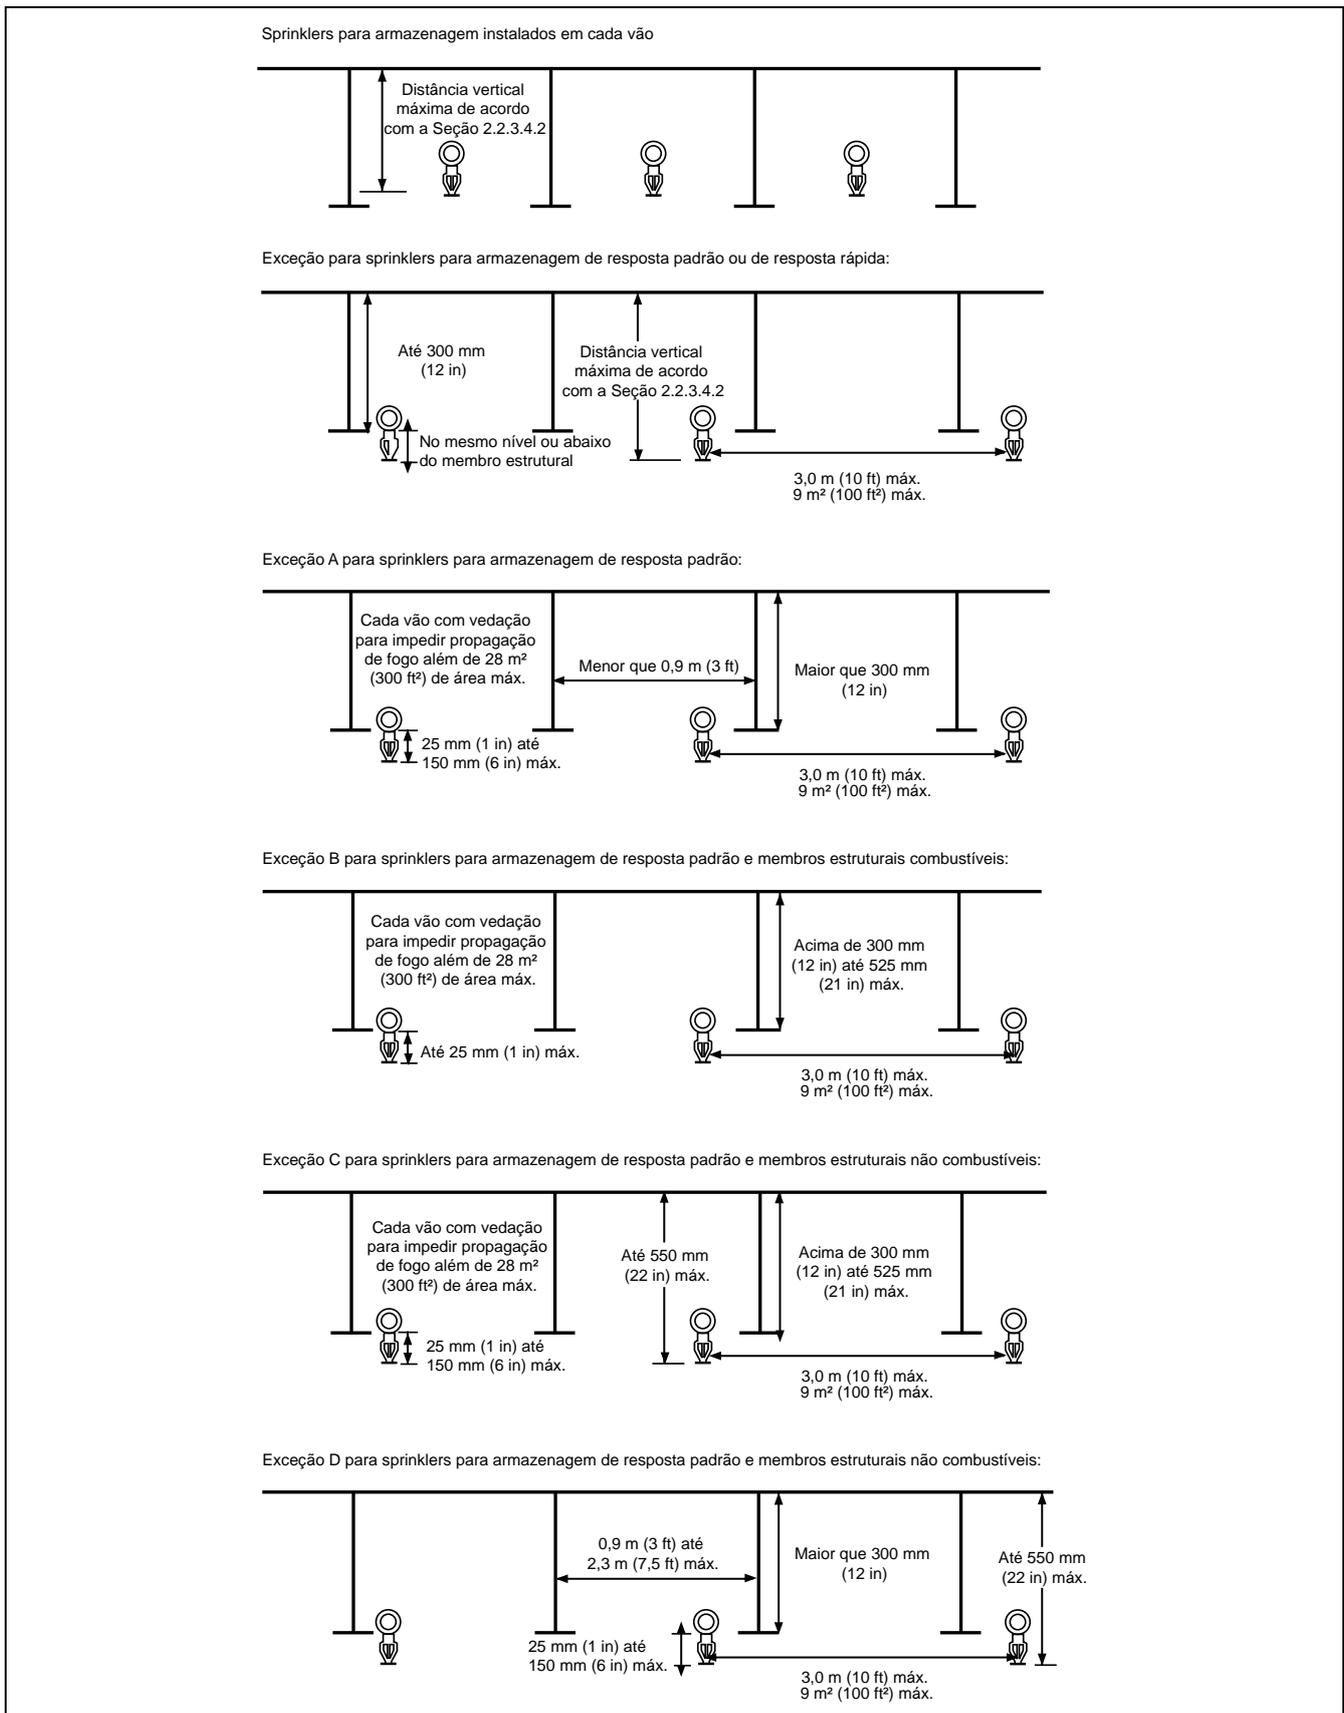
Posicionamento de sprinklers para armazenagem sob construção de teto obstruída.
